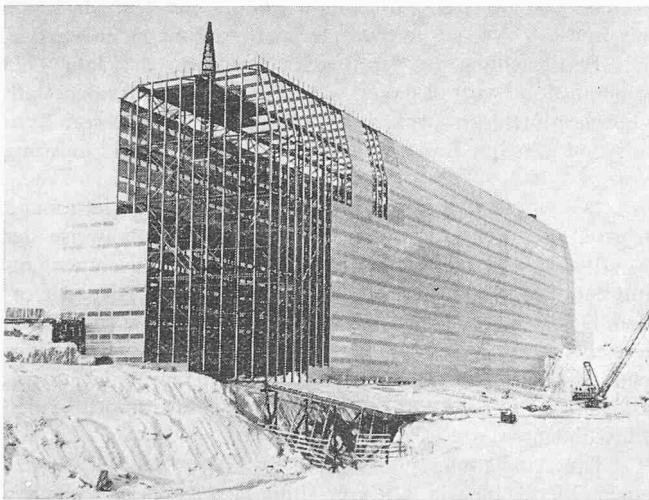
Einkleidung für die abschnittsweise Betonierung der Stau-mauer, bestehend aus einem zerlegbaren Stahlgerüst mit Plastiküberzug, Länge 190 m, Höhe 40 m
